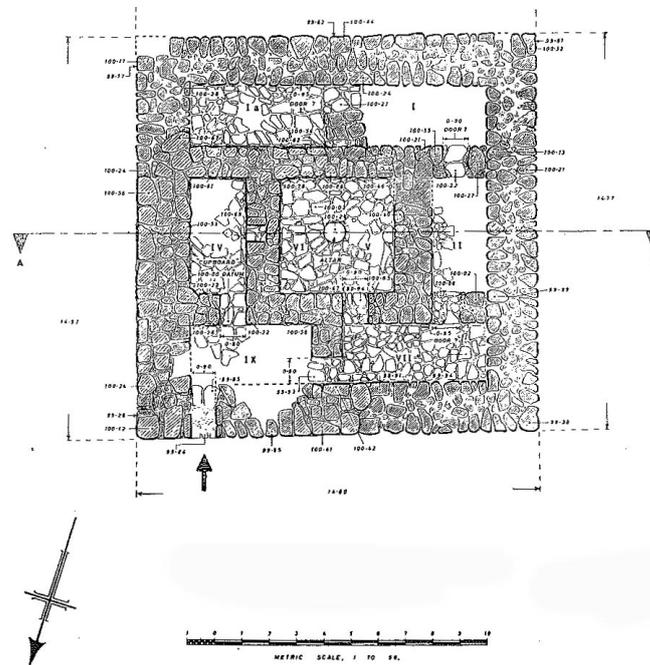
Plan des Gebäudes in der ersten Bauphase
